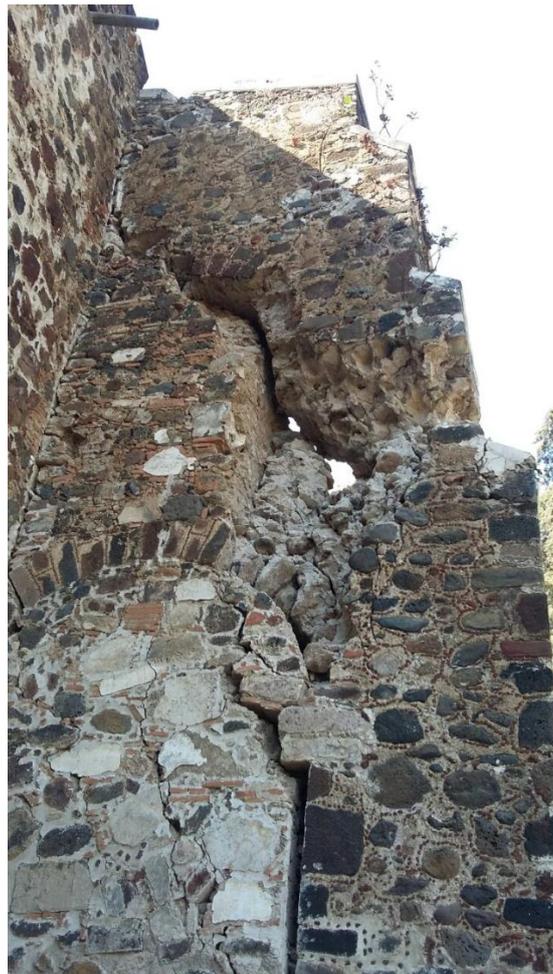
Fracturas en el primer contrafuerte fachada norte del templo, San Guillermo, Totolapan, Mor., 2018. Foto. Laura Moyers Ruíz.
